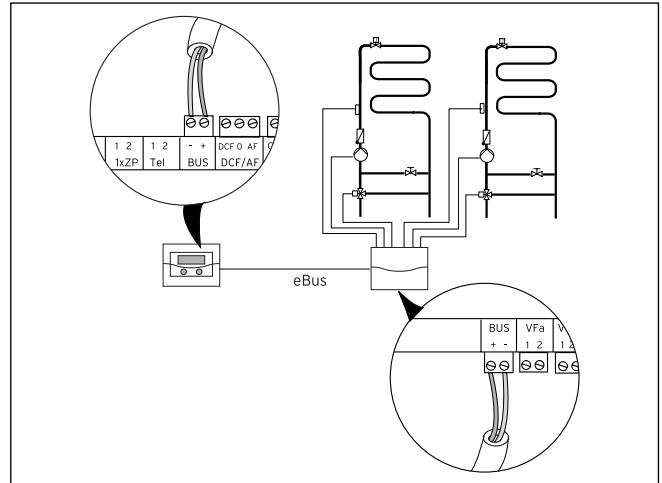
Priklop naprave za daljinsko upravljanje
